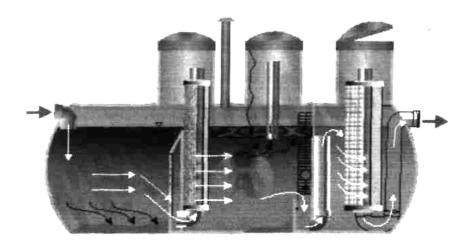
Установка очистки ливневых стоков типа НГП-С. Общий вид
